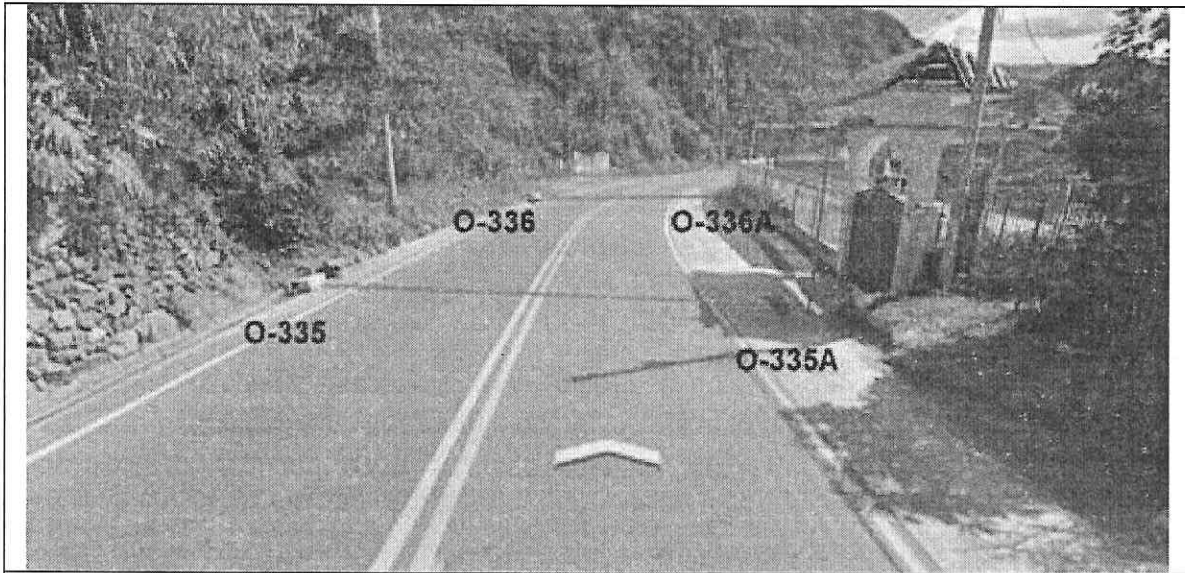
Vista de las 2 alcantarillas existentes previamente al proyecto, se observa los descoles intervenidos por una vivienda (imagen tomada de Google earth).
